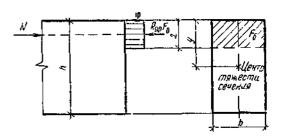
Схема усилий и эпюра напряжений в сечении, нормальном в продольной оси внецентренно-сжатого бетонного элемента, рассчатываемого без учета сопротивления бетона растянутой зоны
